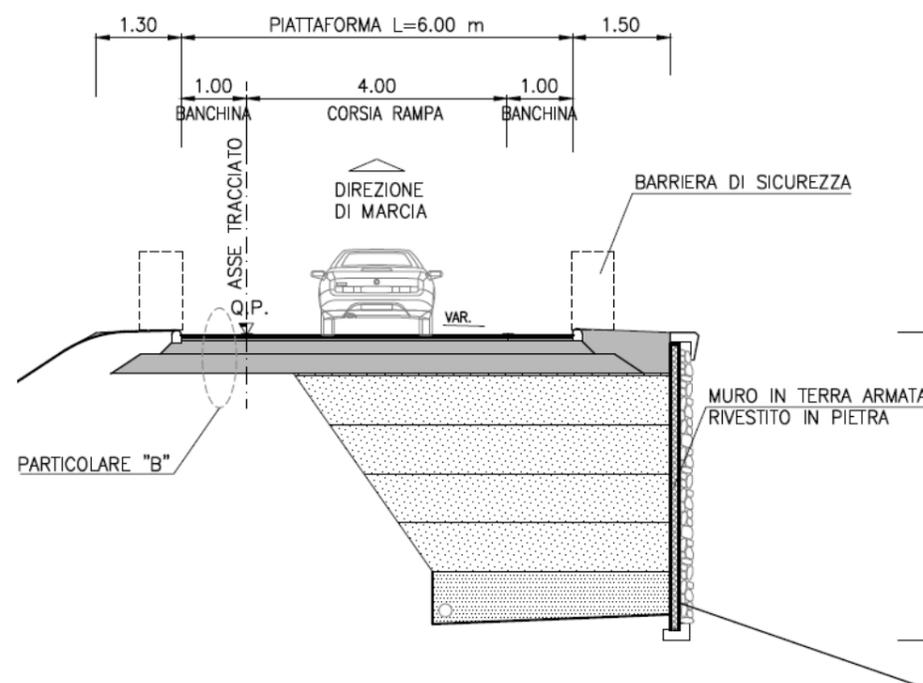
Sezione tipo: rampa su muro in terra armata
